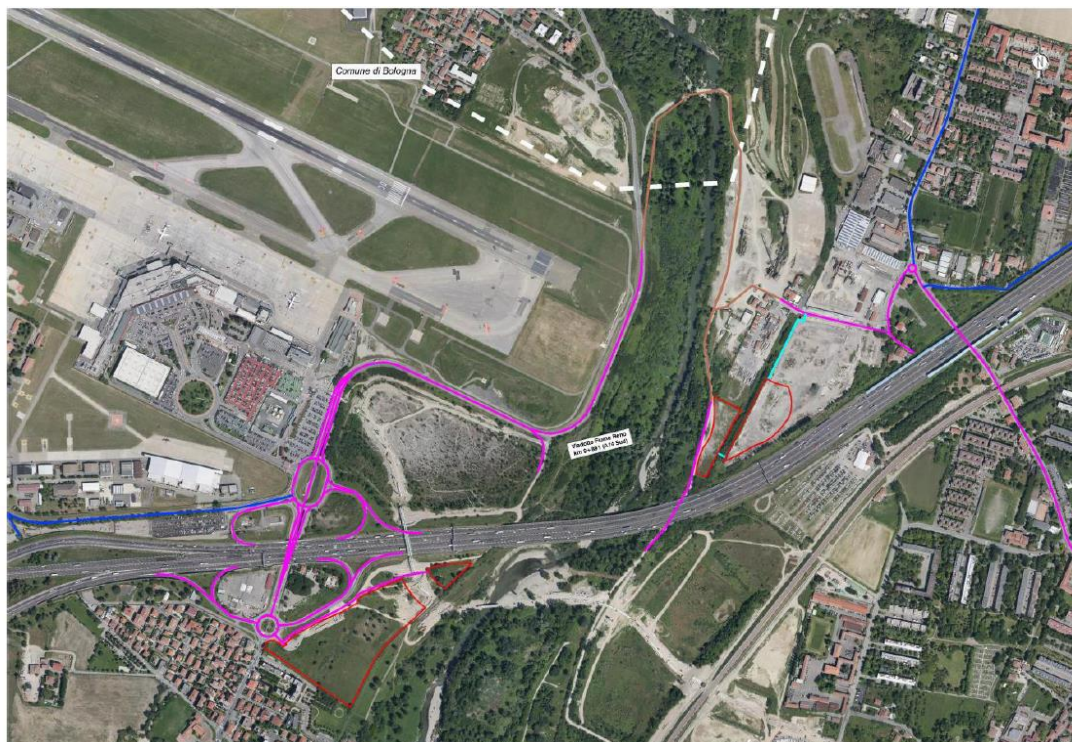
Aree di cantiere (in rosso) e viabilità di accesso al cantiere del viadotto Reno
